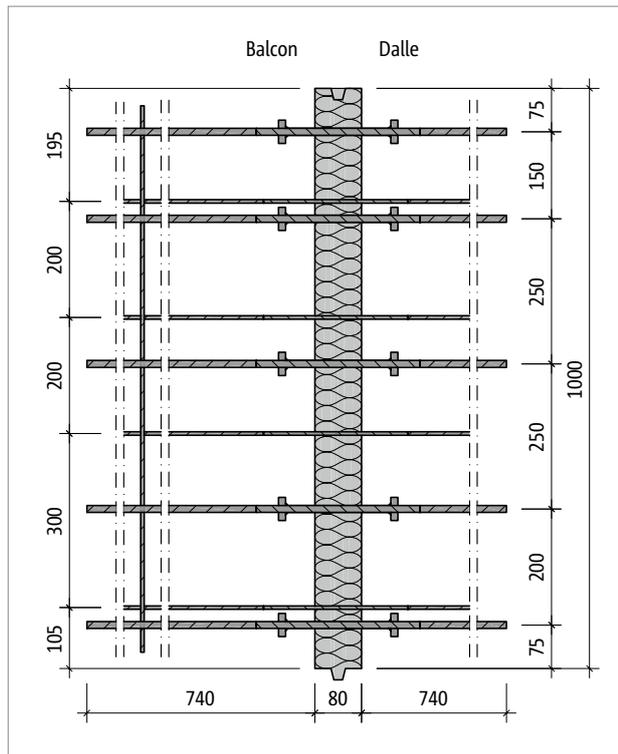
Schöck Rutherma® T type DB-M1-V1 : vue en plan du produit
